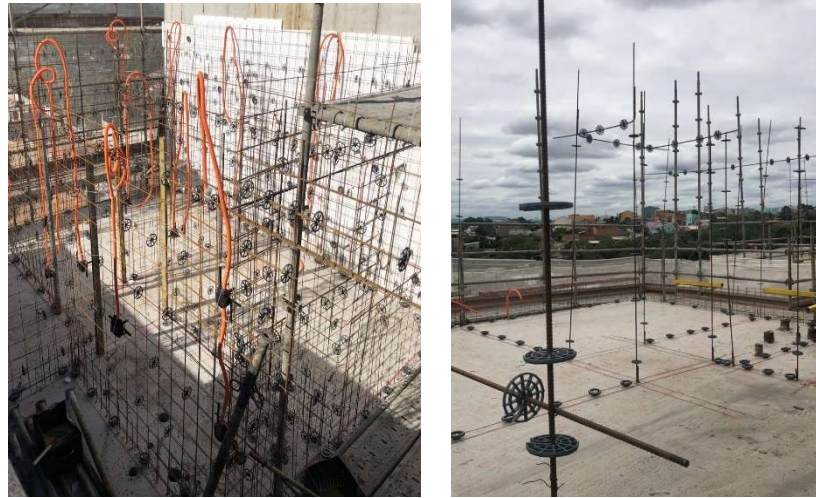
Ilustração de reforço em estrutura de concreto armado (a) e CRF (b)
